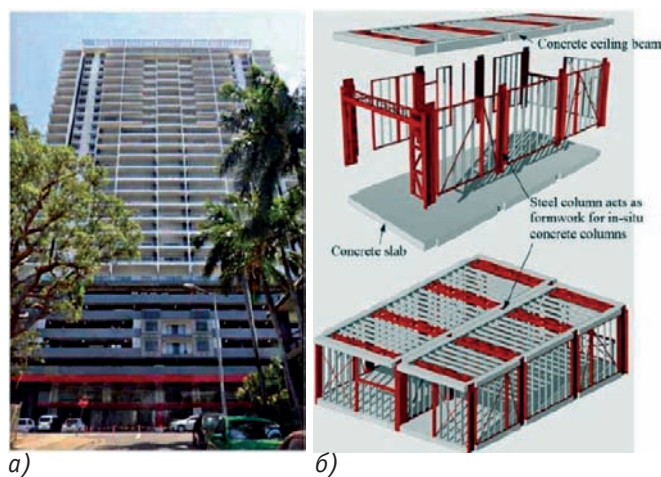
Башня SOHO. Австралия: а) фасад здания; б) модульный блок
